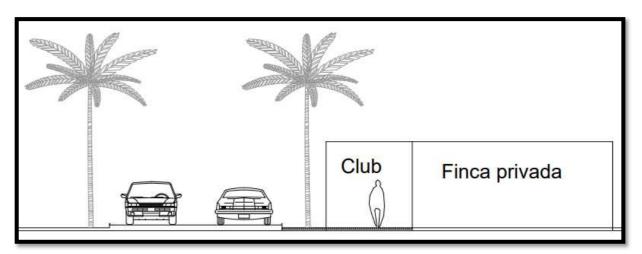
Sección transversal tramo 1. Fuente: Elaboración propia.
